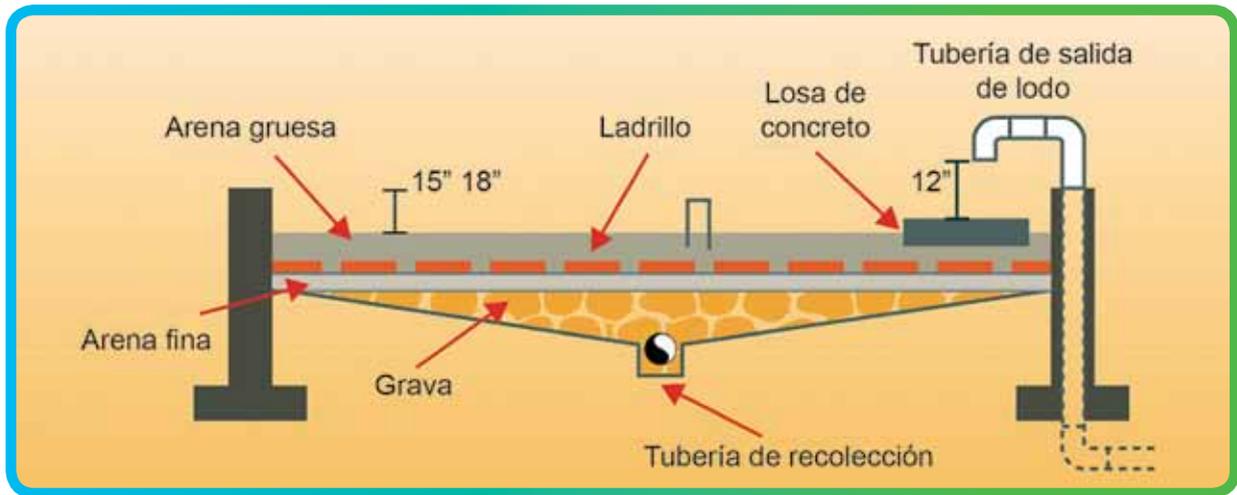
Corte transversal de una planta de lecho de secado.
